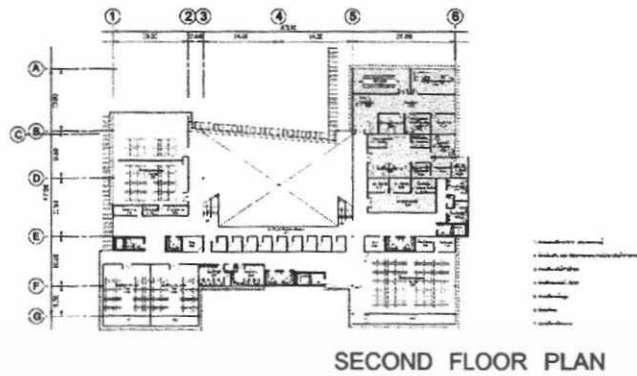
ภาพแสดงแนวความคิดในการออกแบบ Theme โครงกา Plan และ Elevation
